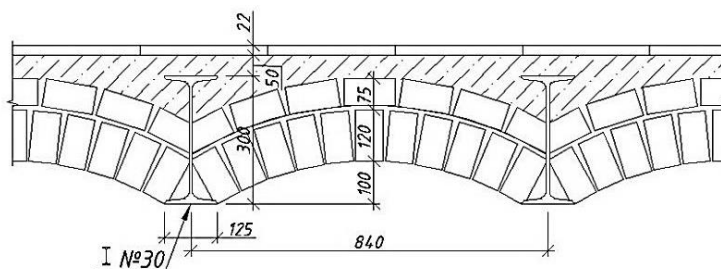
Конструктивное решение междуэтажного перекрытия корпуса Б
